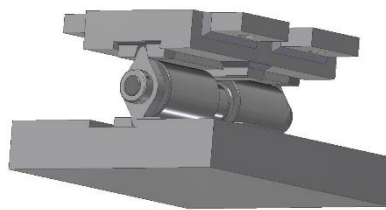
Lagertyp Re,L, zur Führung und Sicherung der Rolle mit Stegeisen, beidseitig Stahlanschluss.
